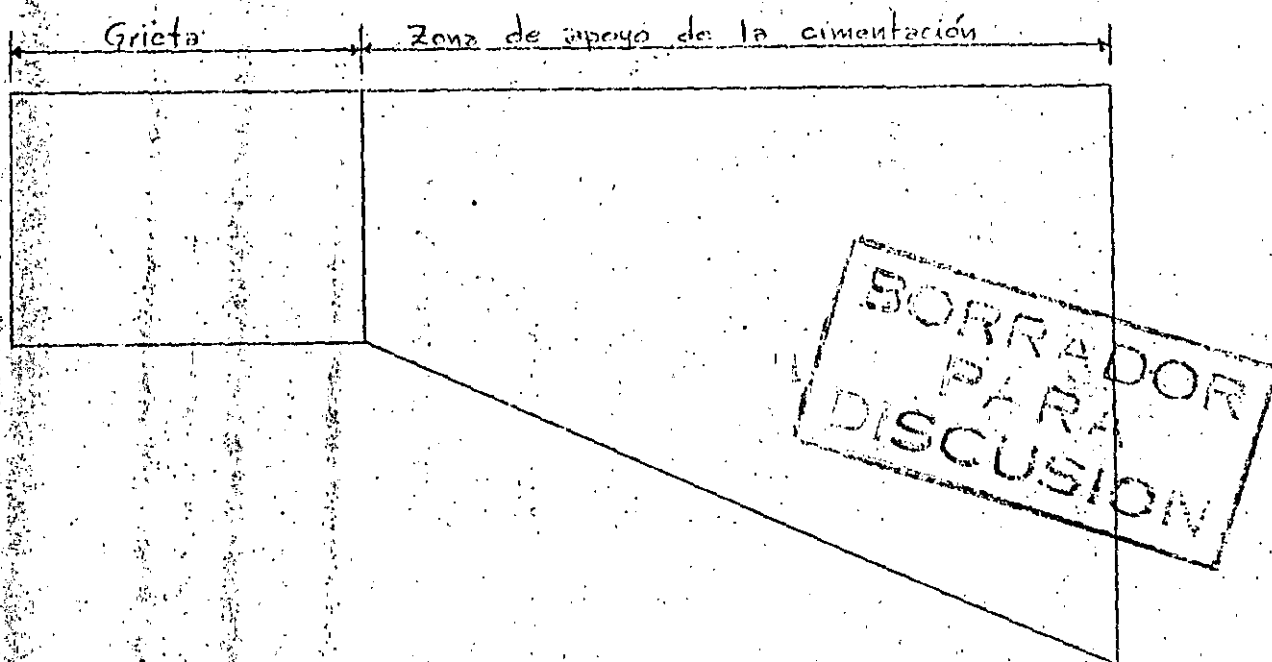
Grieta y zona de apoyo de la cimentación en una presa de gravedad.
